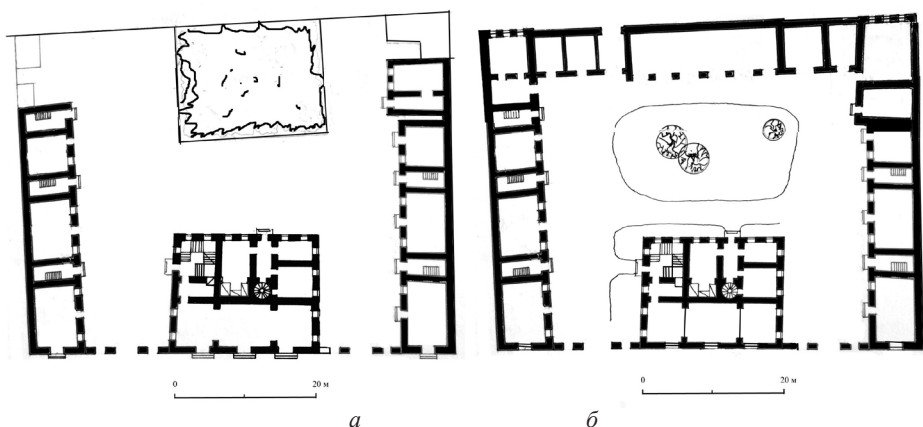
Генплан усадьбы, совмещенный с планами зданий по первому этажу: а – на 1829 г.; б – на конец XIX в. Реконструкция С. М. Шумилкина
